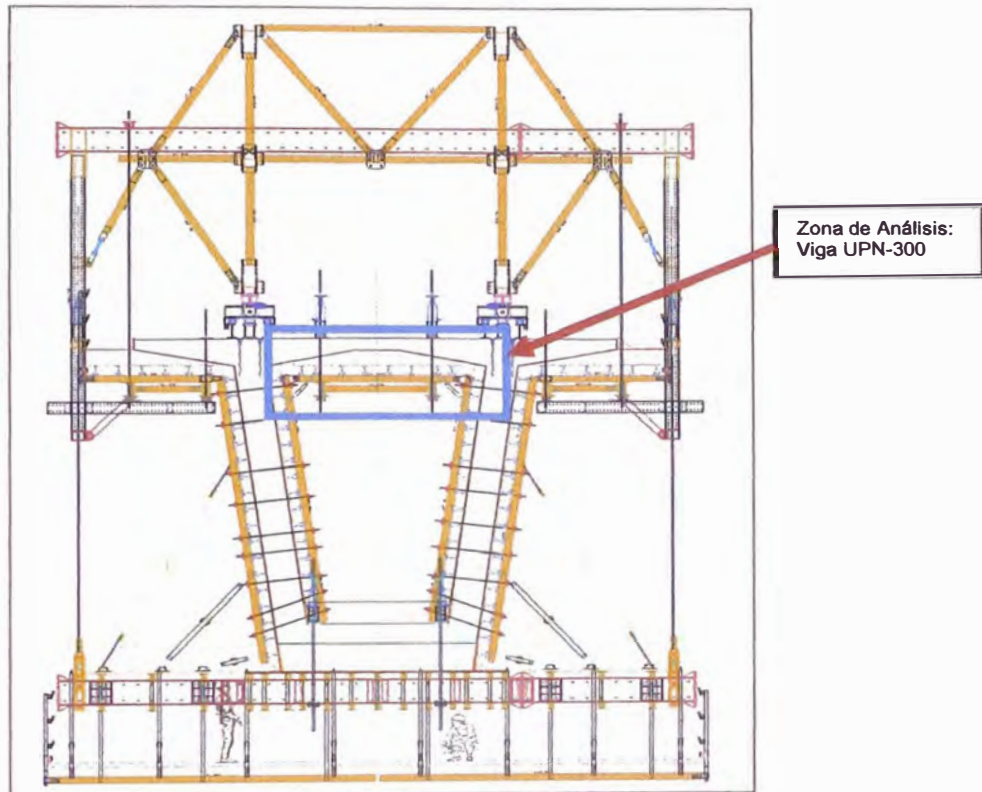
Zona de Análisis - Losa Superior Interior - Viga UPN-300.
